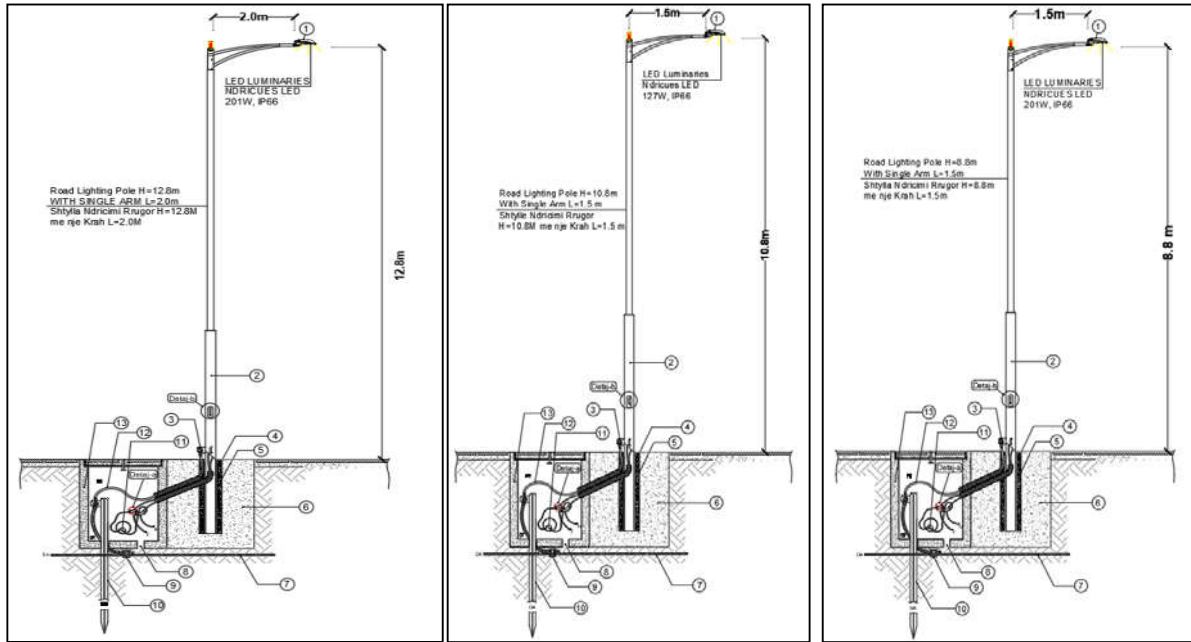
Detajet e shtyllave të ndriçimit të përdorura për ndriçimin e kryqëzimeve, zonës së parkimit dhe rrugëve lokale
